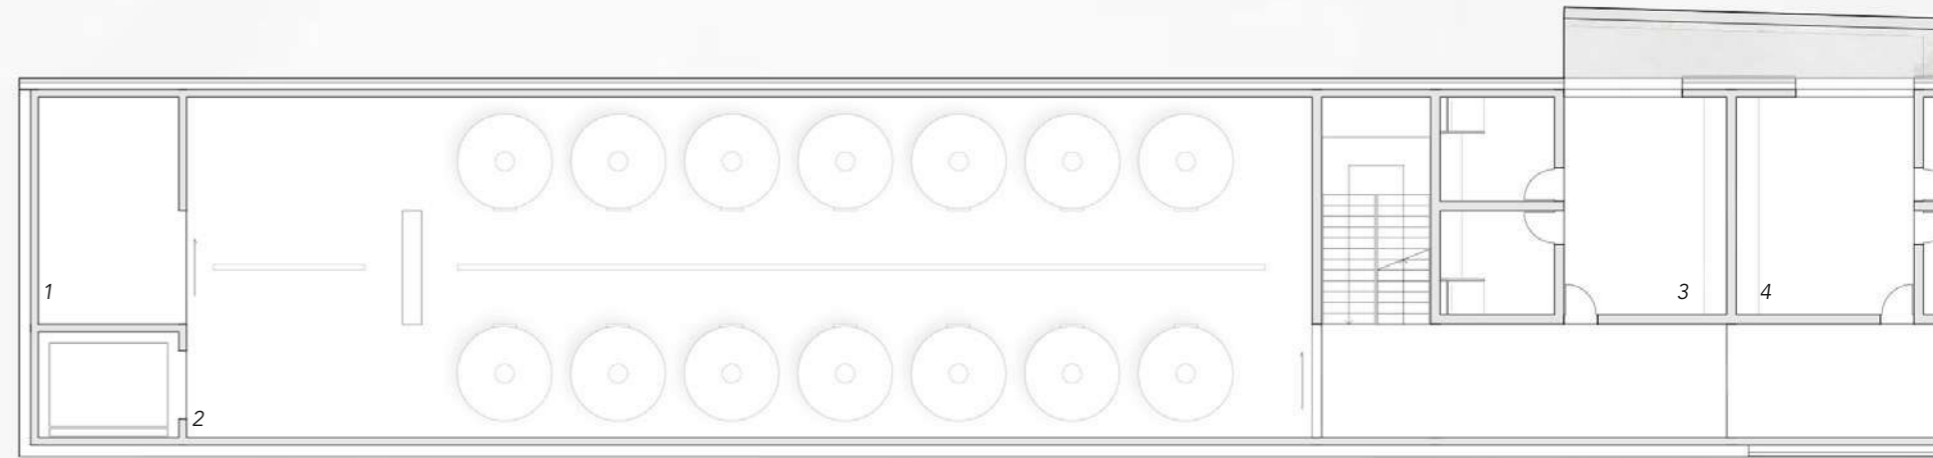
Grundriss Kellergeschoss M 1:200
